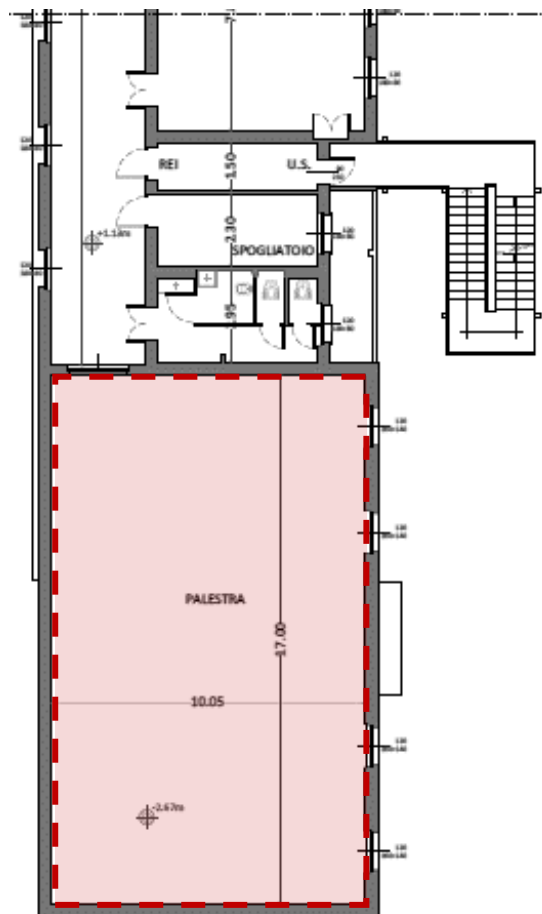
Pianta piano terra (in rosso trattamento acustico)
